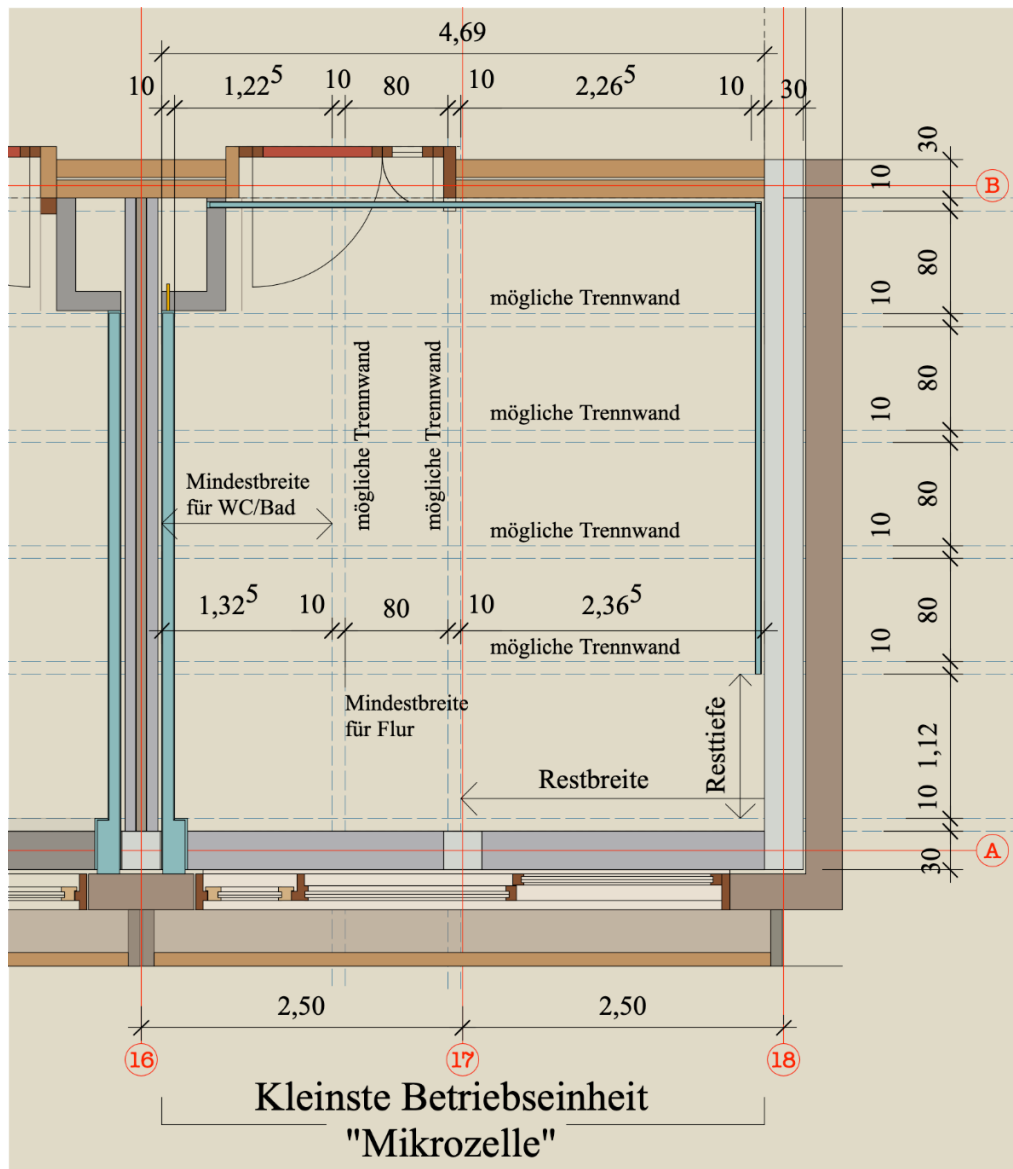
Grundrissdarstellung - Entwicklung eines Raumrasterystems innerhalb der kleinsten Betriebseinheit
